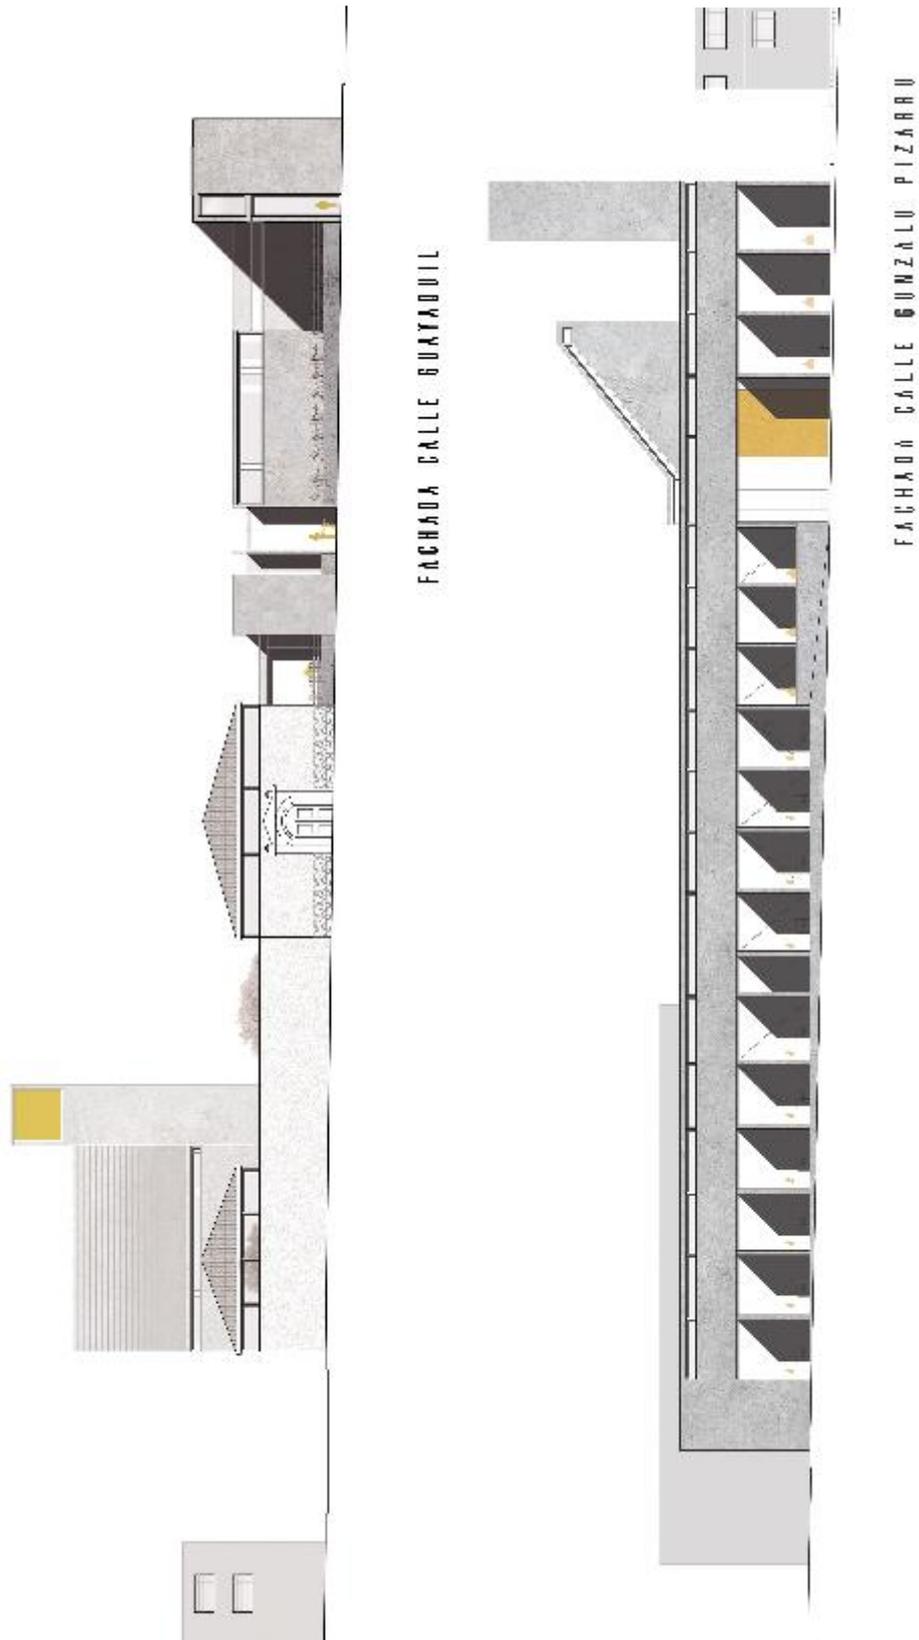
Fachada Calle Guayaquil. Figura 88. Fachada Calle Gonzalo Pizarro. Elaboración propia.
